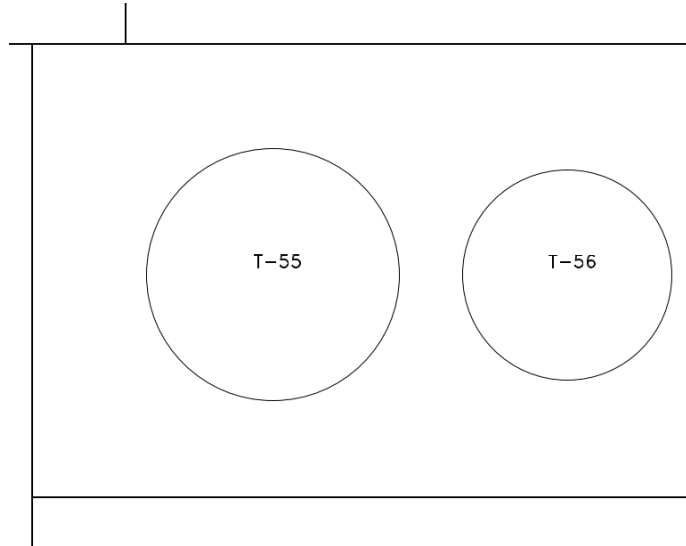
Planimetria dei serbatoi T-55 e T-56 nella configurazione di pre-conversione.
